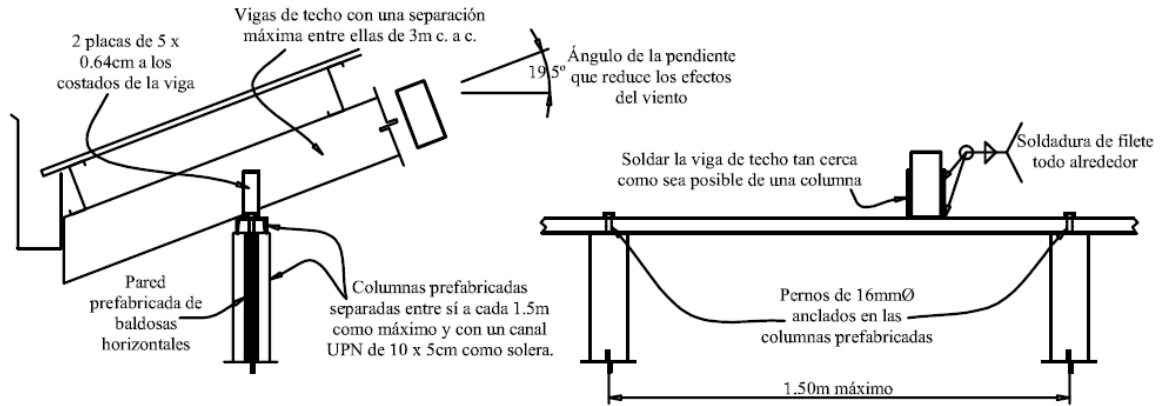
Detalle de apoyo de viga de techo en pared prefabricada de baldosas verticales
